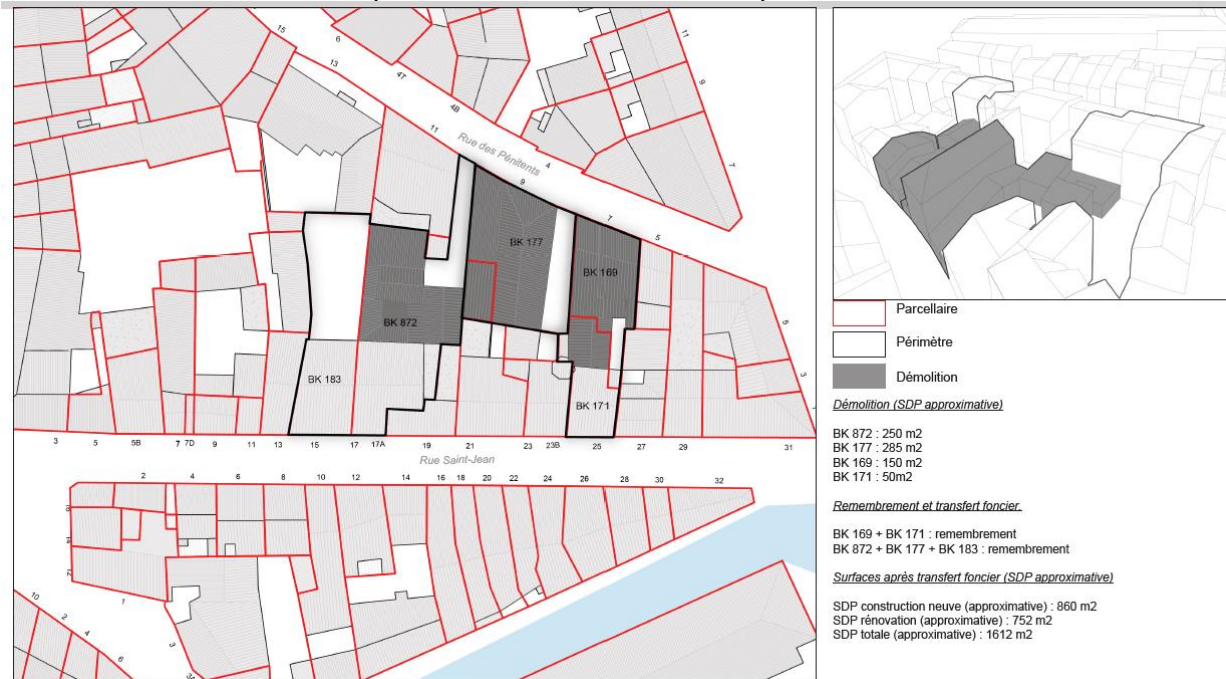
Plan masse – Rez-de-chaussée du scénario « ORI »
